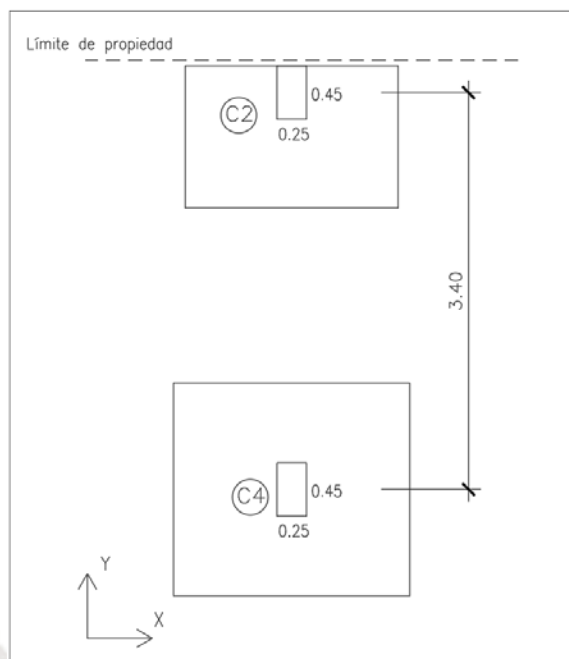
Croquis de columnas C-2 y C-4 con sus zapatas
